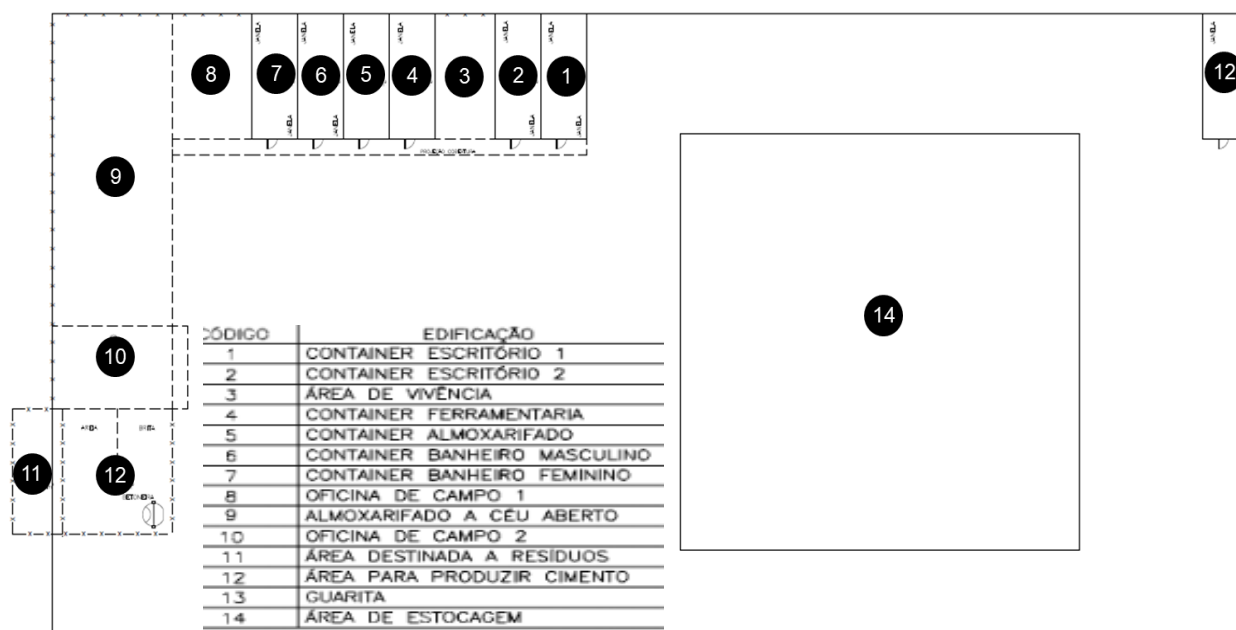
Layout típico dos canteiros da Estrada Honório Bicalho, Canteiros Avançados 1 e 2 e Canteiro da nova subestação 930-SE-01.
